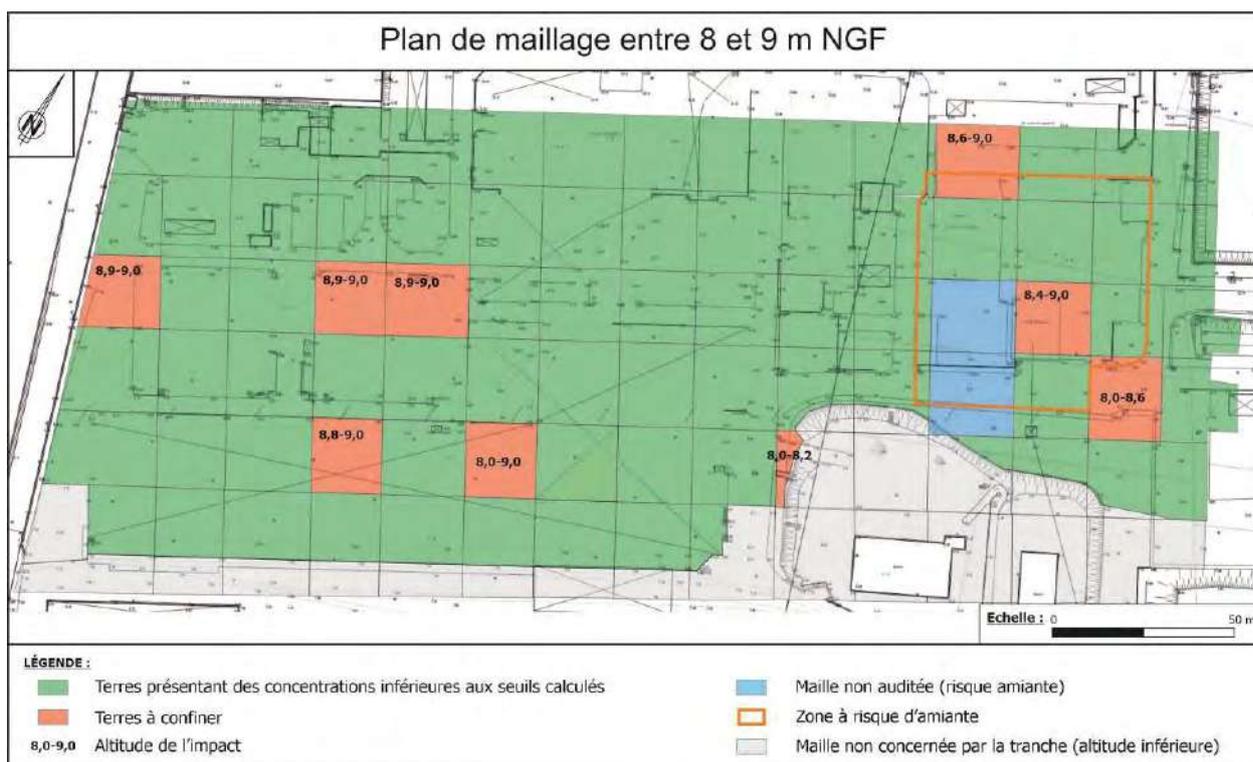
Plan de maillage entre 8 et 9 m NGF
